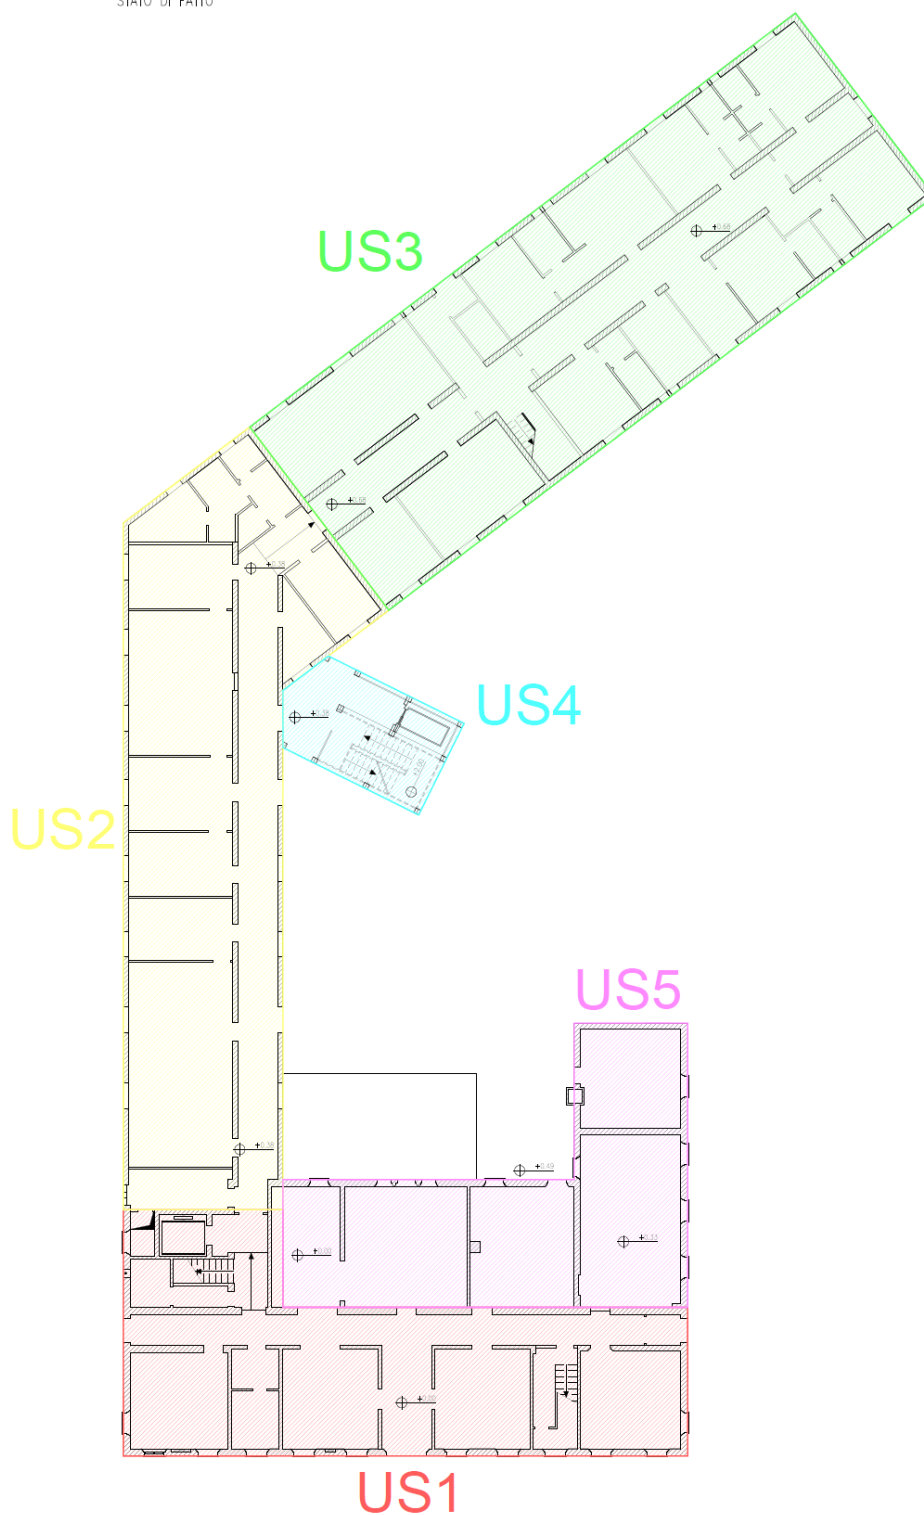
| Pianta Stato di Fatto Piano terra con indicazione differenti unità strutturali
